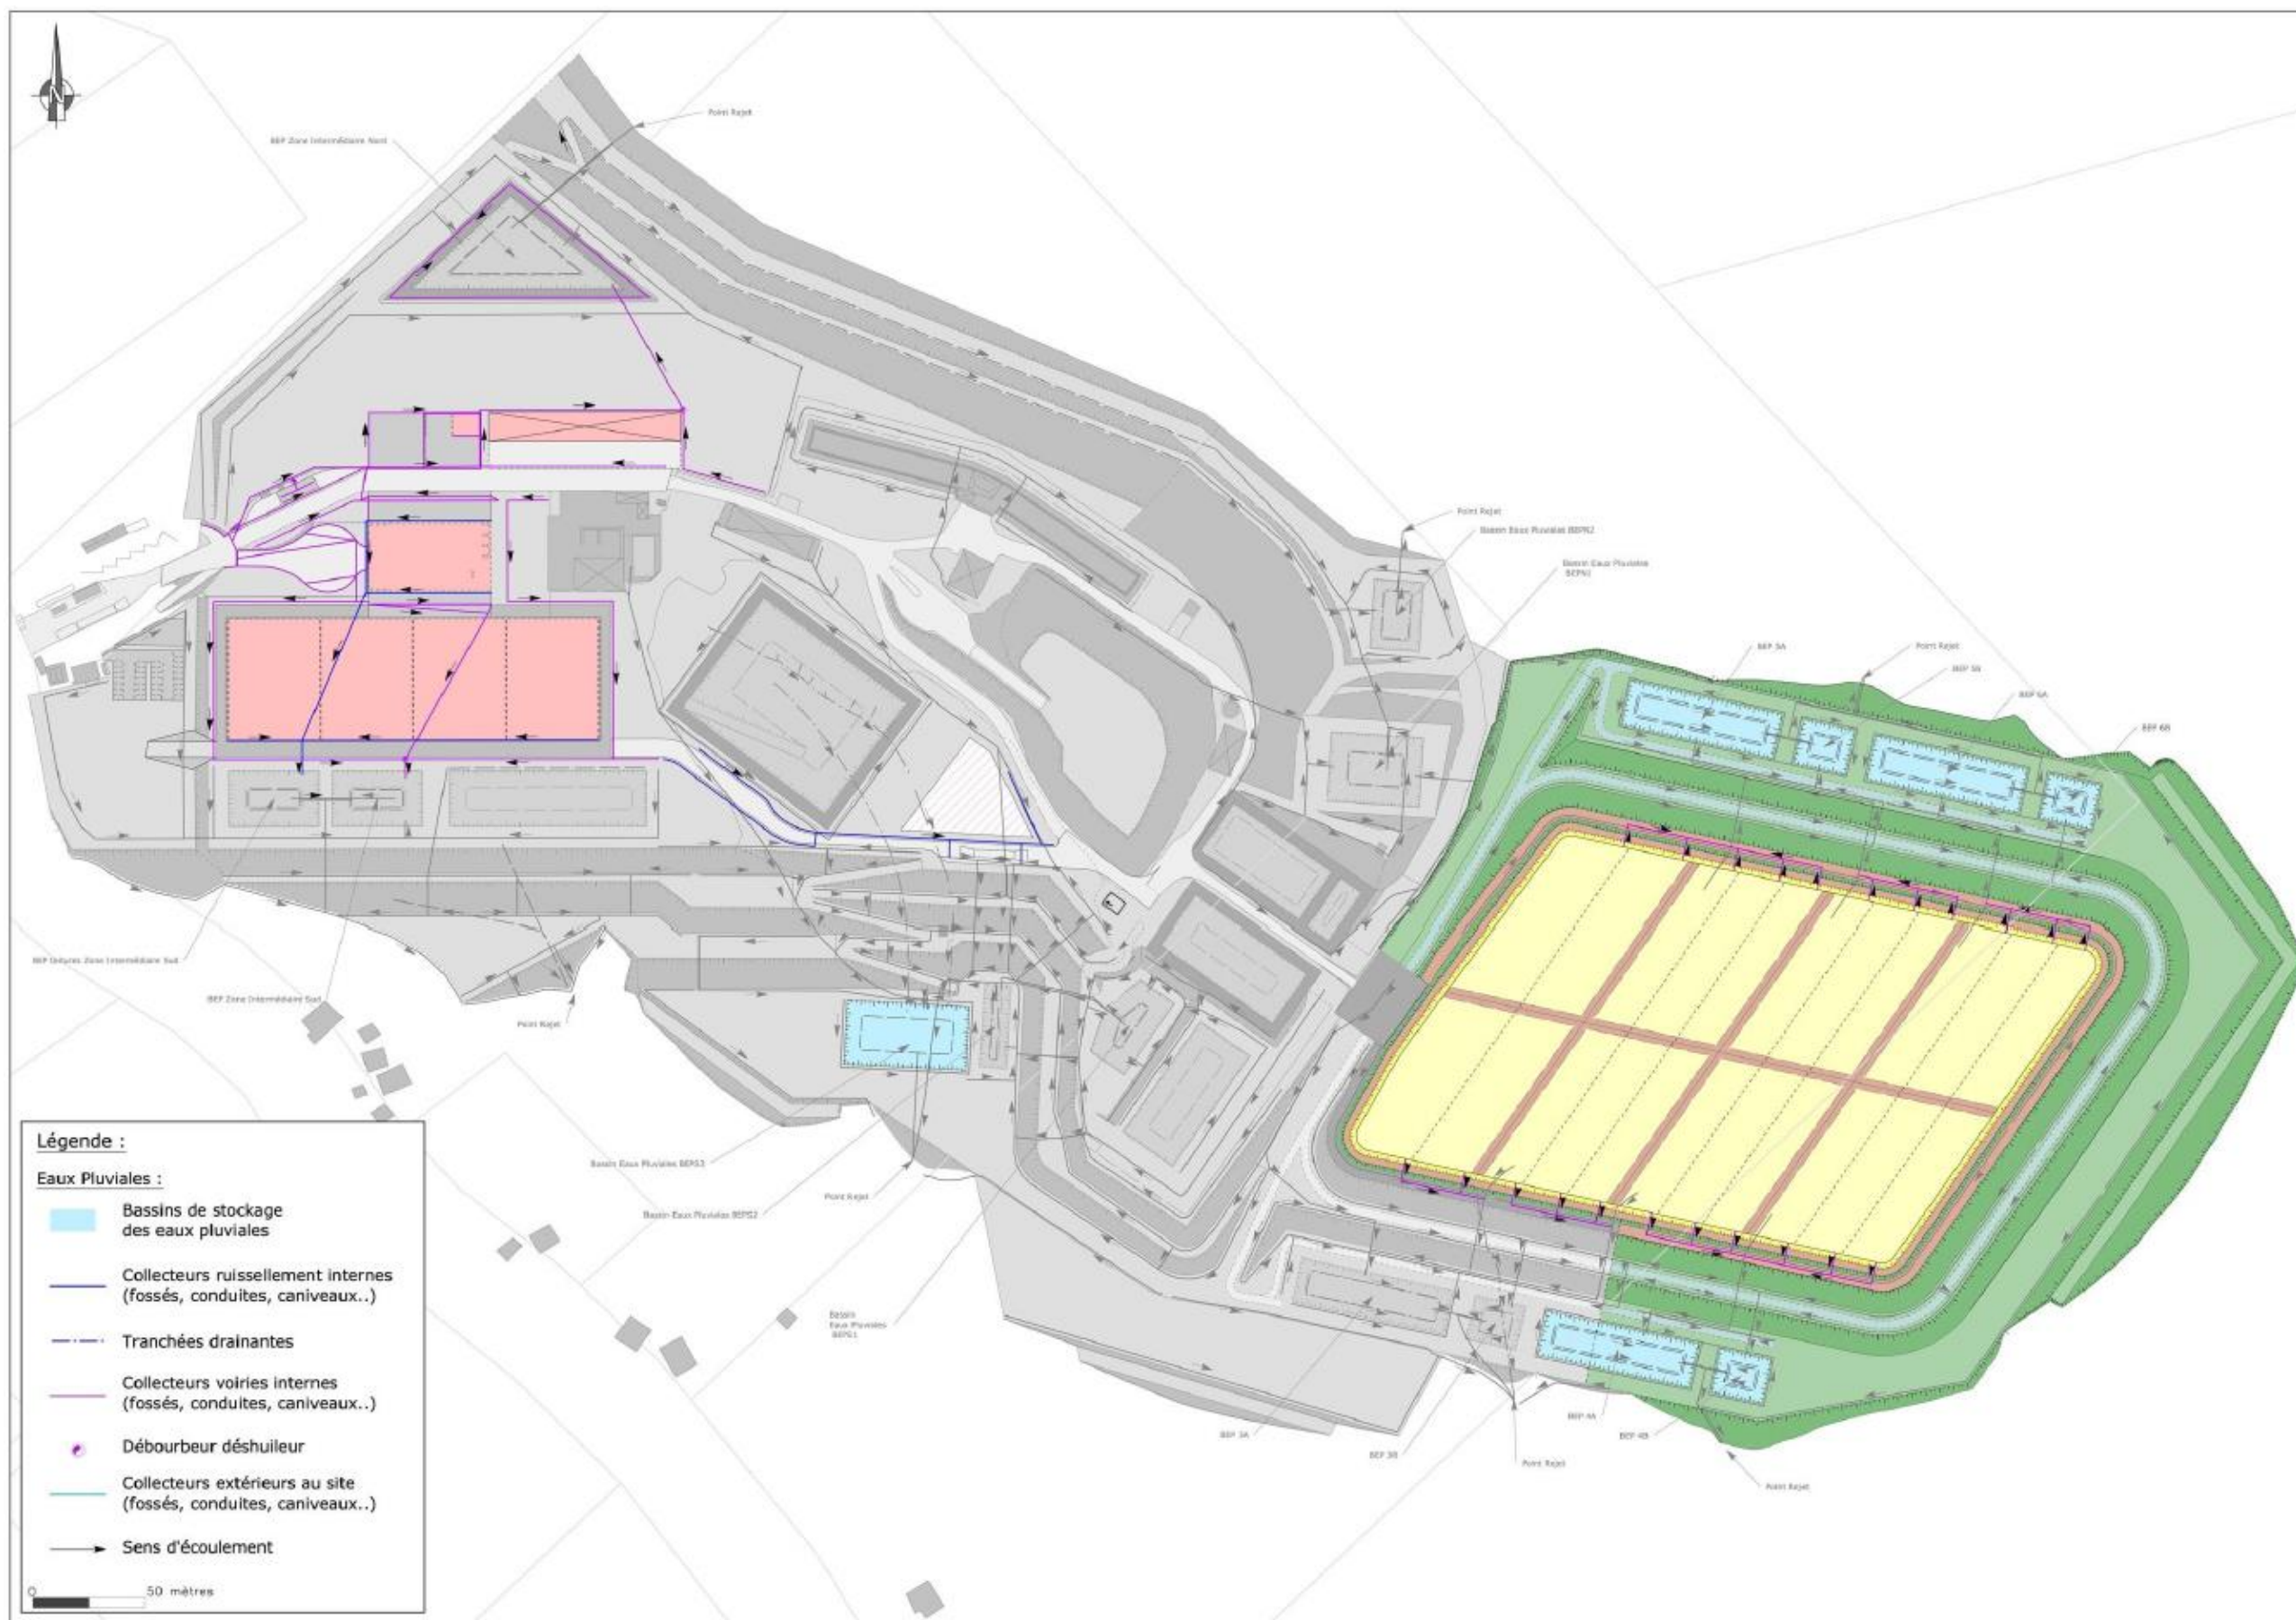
Plan de la gestion des eaux niveau 2 (Source : BETA Environnement)
